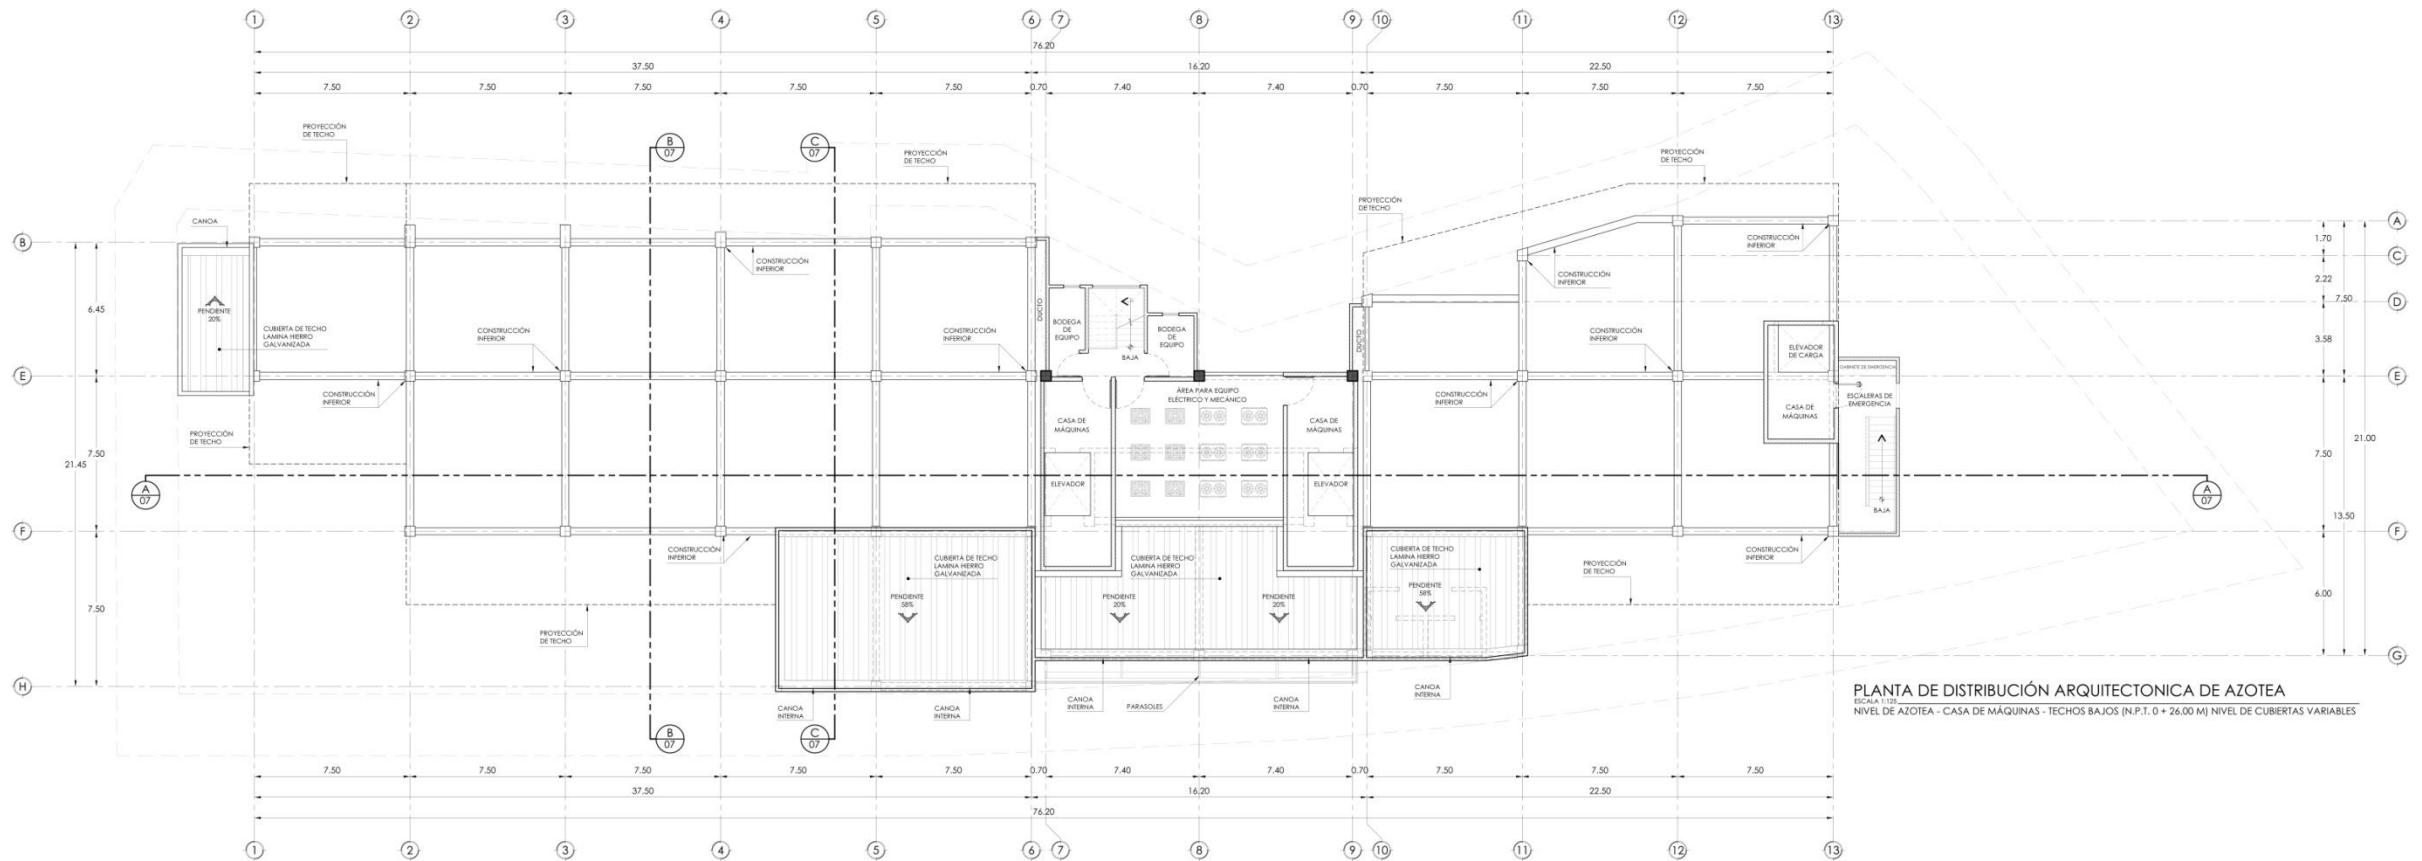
Planta Arquitectónica, Nivel de Azotea
